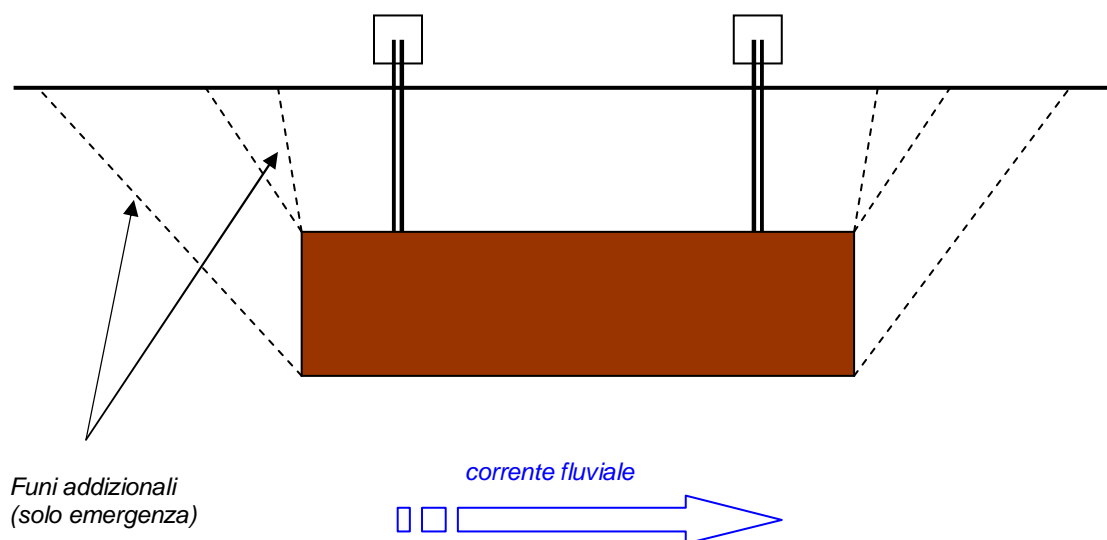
Configurazione d'ormeaggio con bracci distanziatori
